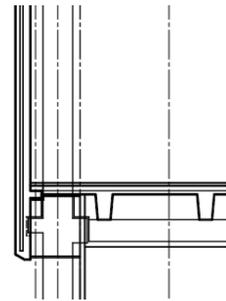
Wärmebrücke Stahlbetonstütze EG
